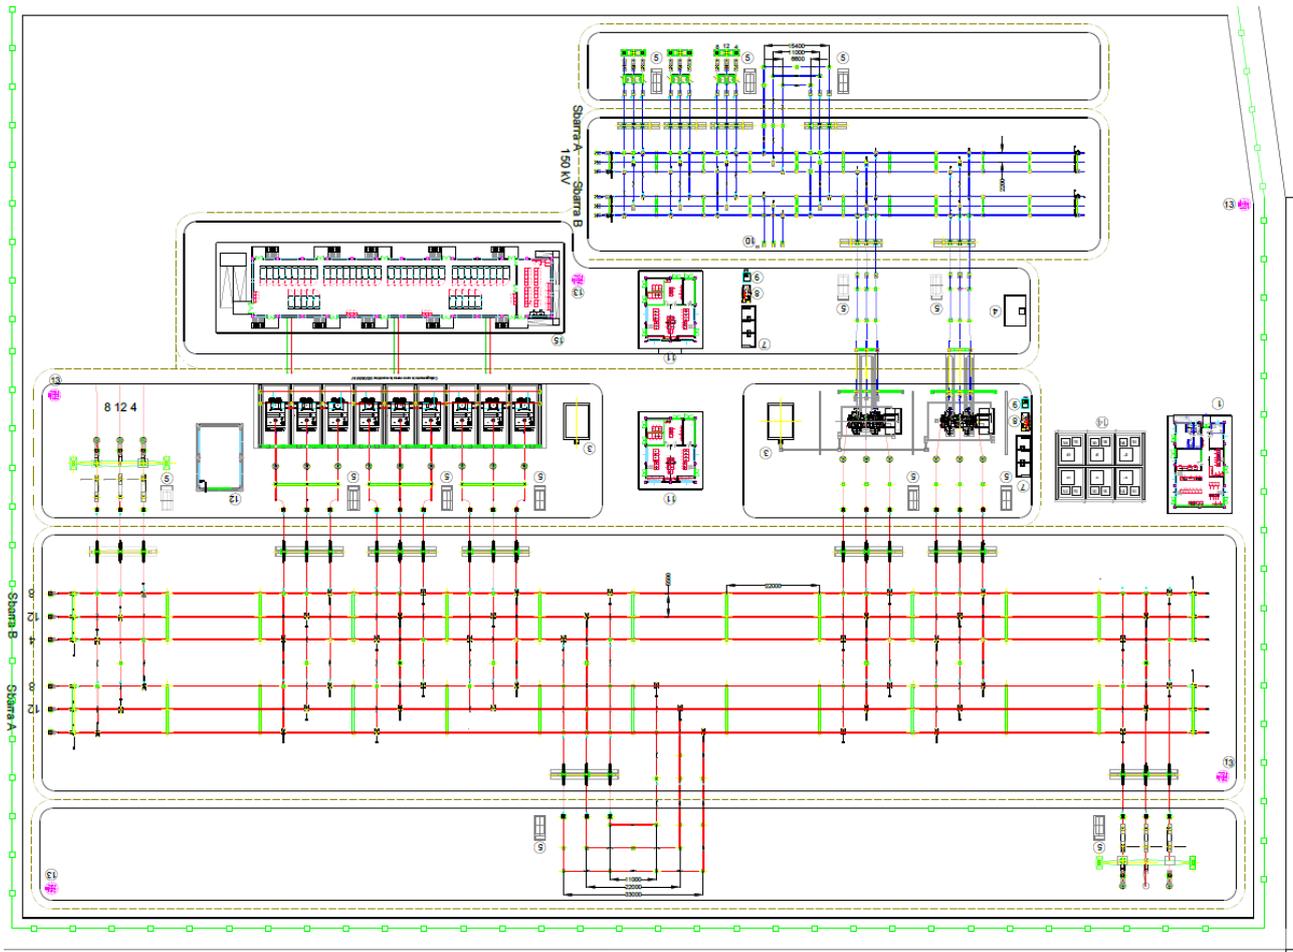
PLANIMETRIA ELETTROMECCANICA GENERALE
